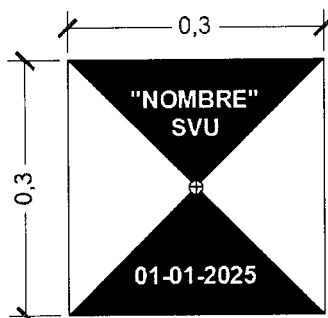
Monolito de Hormigón, vista en planta y sus dimensiones.
